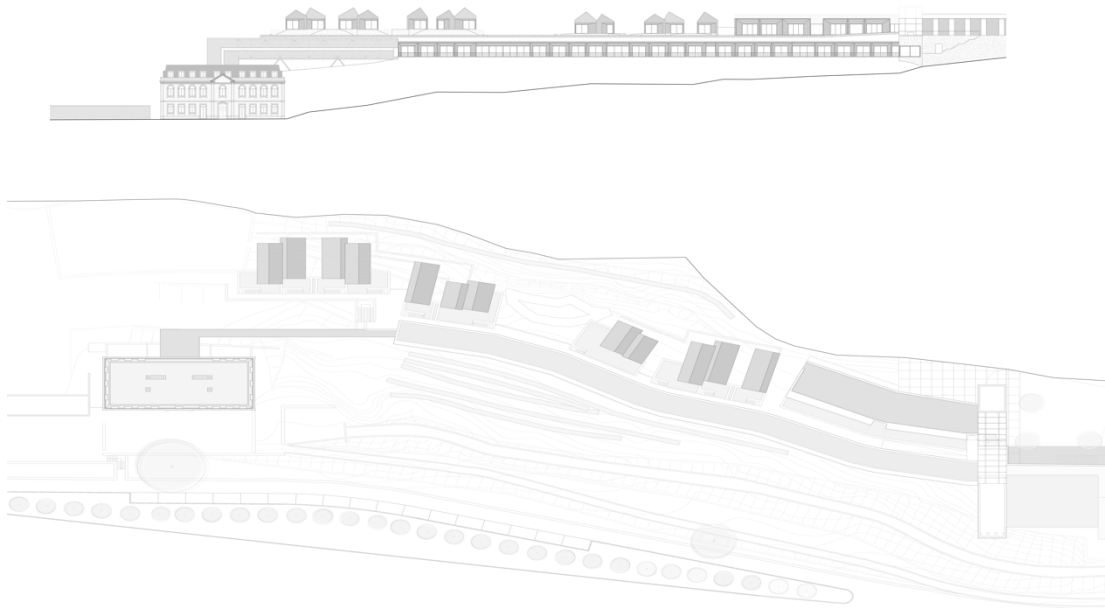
Conjunto de planos (2016). Fuente: Atelier Rebelo de Andrade.
